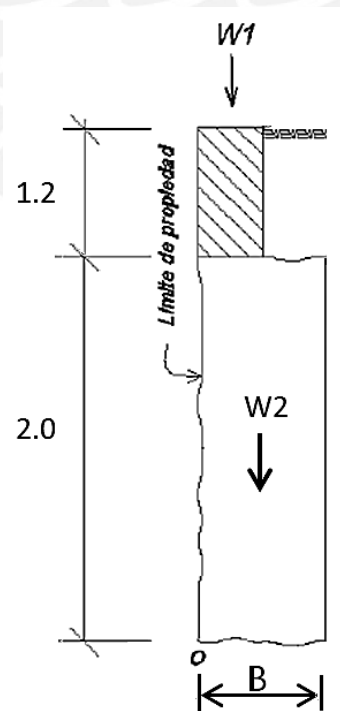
Dimensiones de la calzadura para los cálculos.
